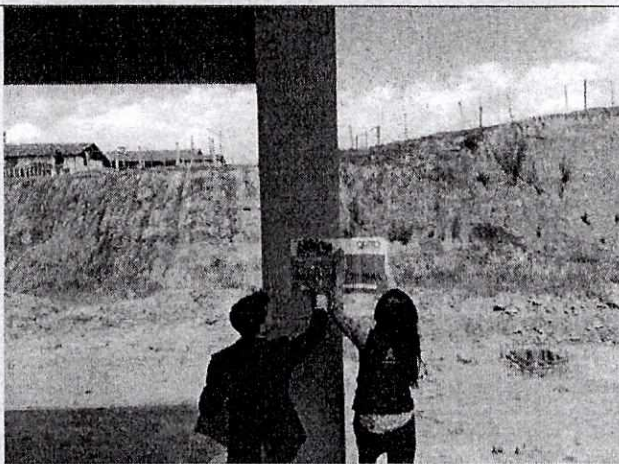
Colocación de sello de suspensión en el acceso – ubicación posterior de la edificación.
